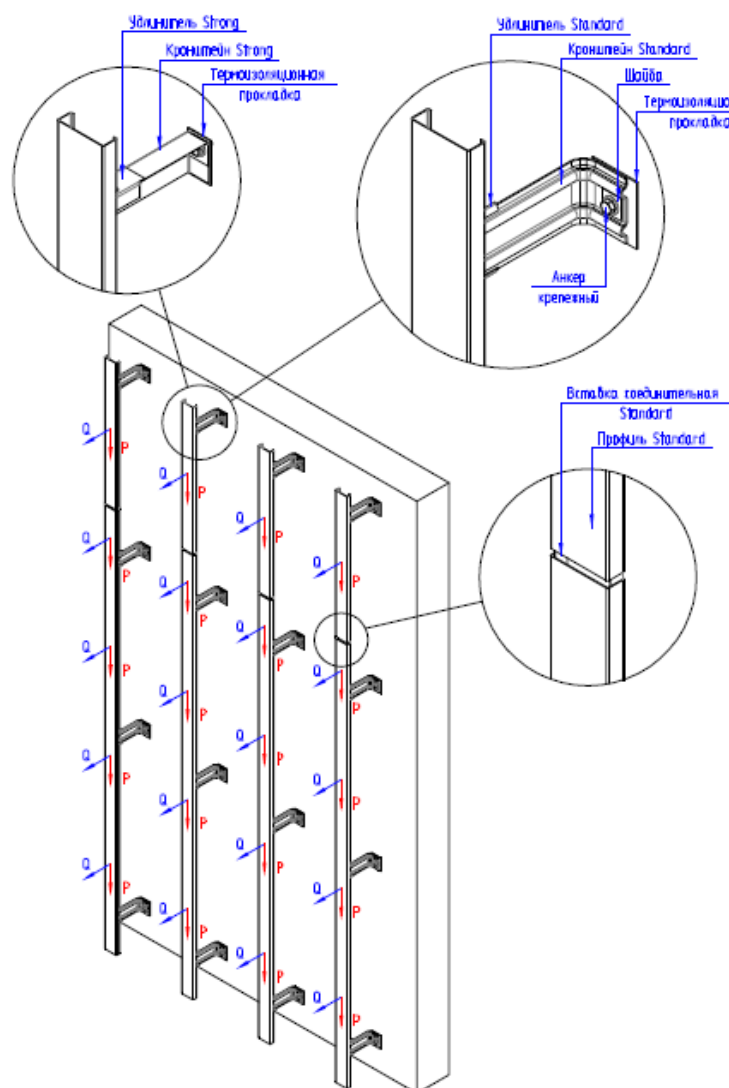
Рядовое исполнение фасадной системы AC-100
